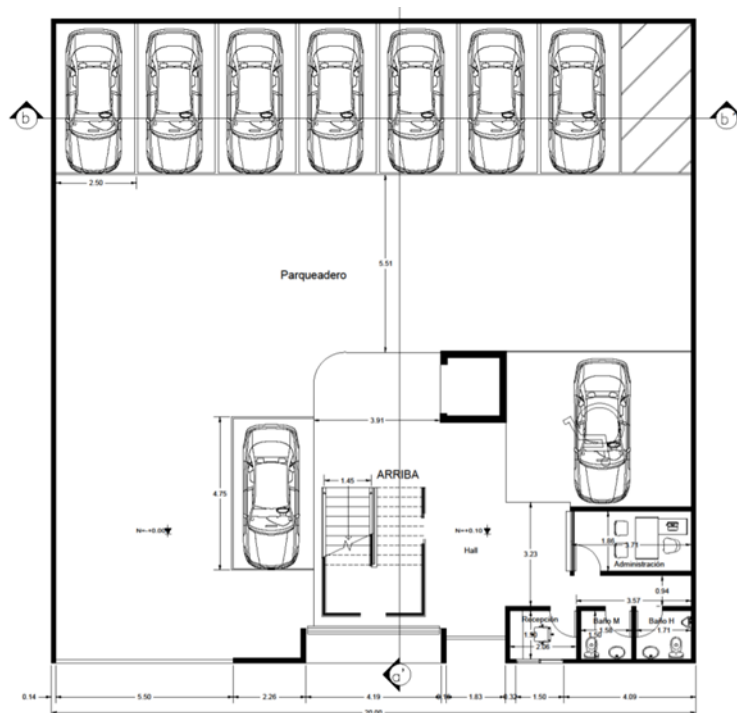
Vista en planta del primer nivel, constructora Proyectos y Soluciones de Ingeniería P.S.I. Ltda. Fuente: Creación propia.
